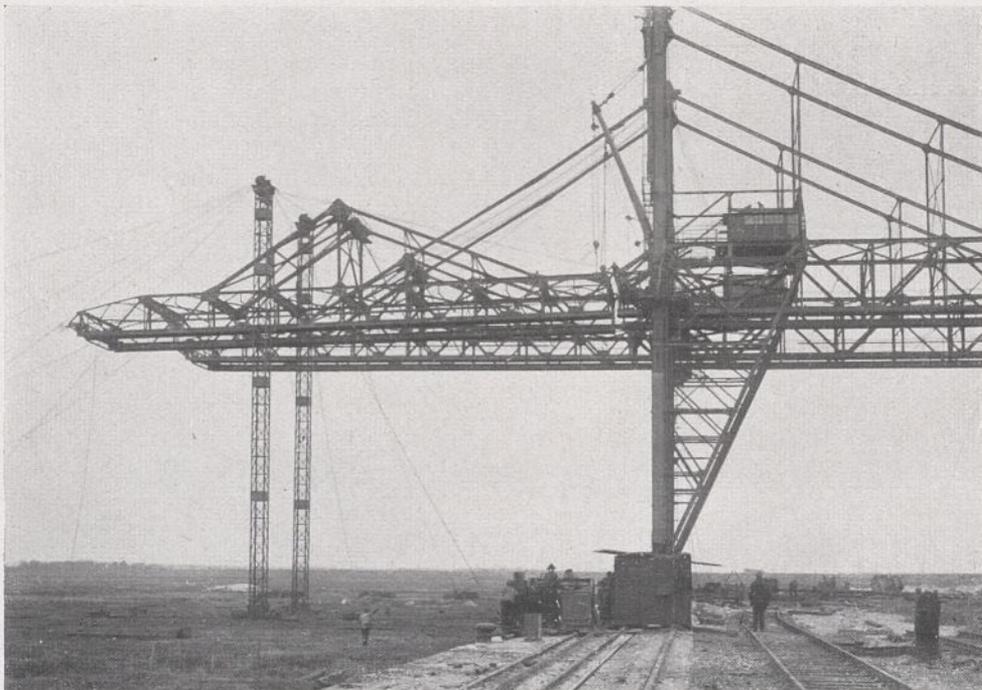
Aufbau der Ausleger der Erzverladebrücken.
